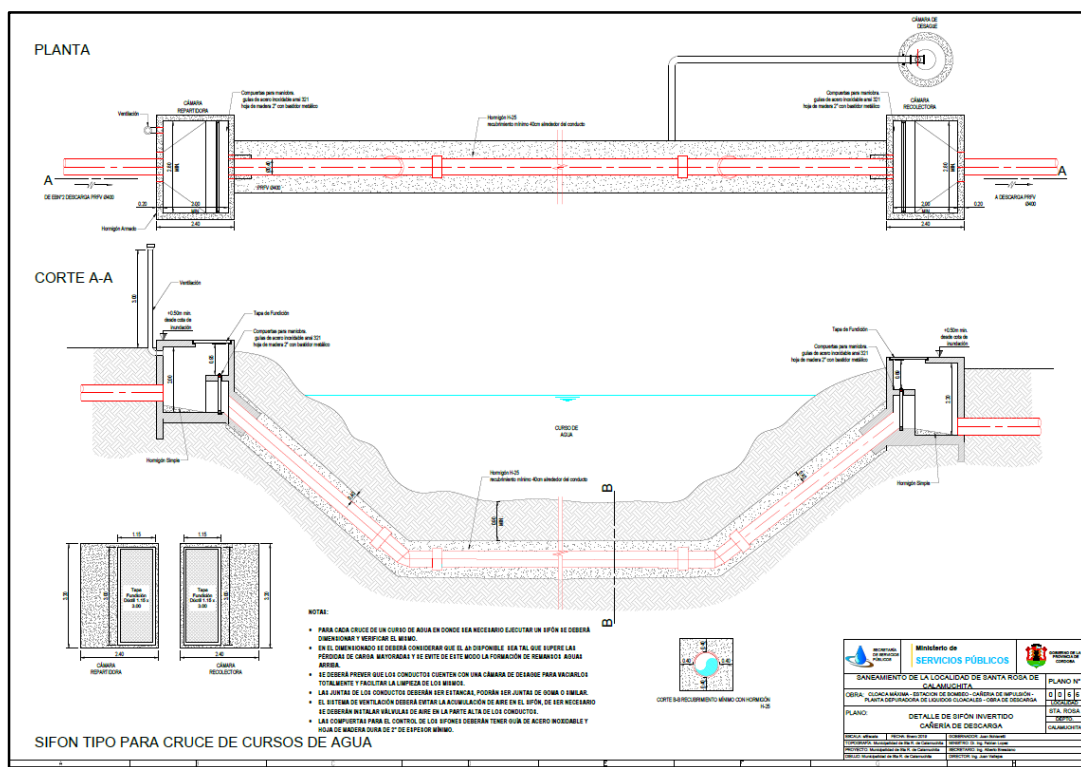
DETALLES DE LA OBRA DESCARGA SOBRE EL RÍO SANTA ROSA.
